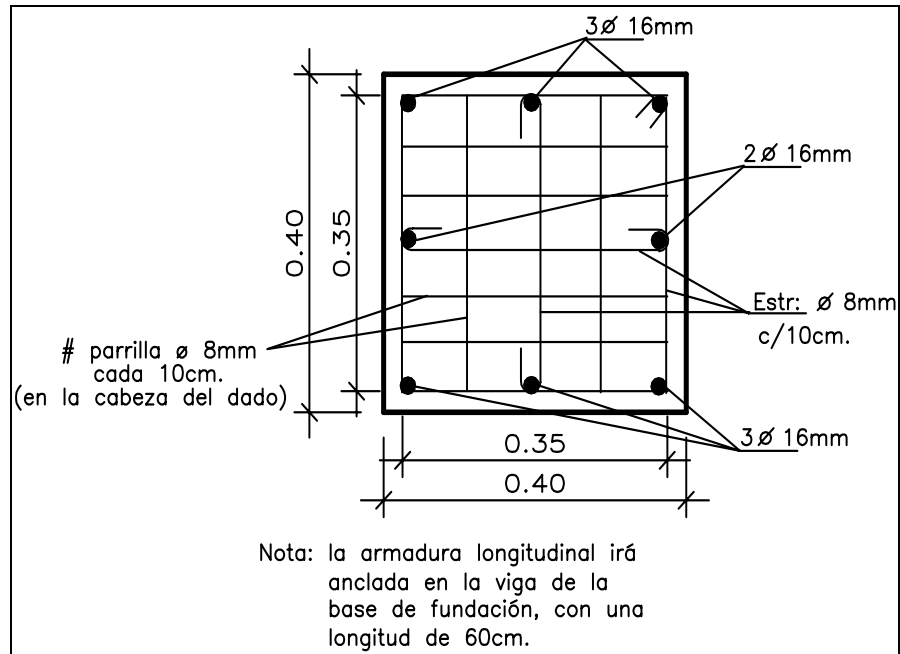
Detalle de disposición de armaduras en dado de hormigón armado donde se apoya el edificio durante la etapa de construcción y previo al montaje del sistema de aislamiento (Ver también Capítulo 9).
